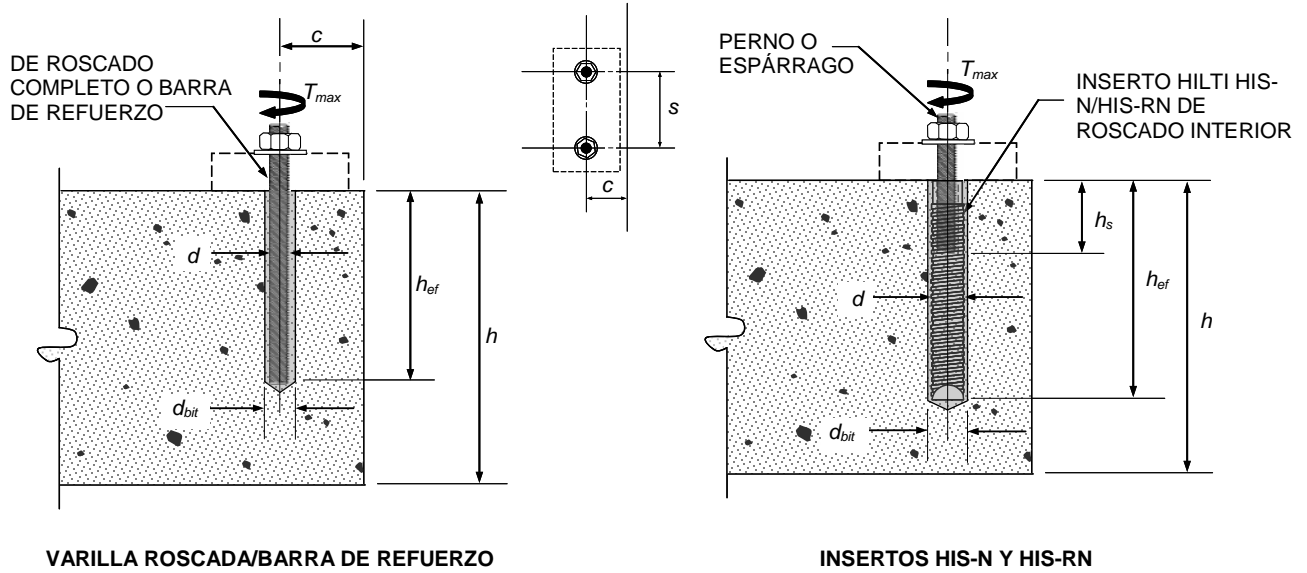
PARÁMETROS DE INSTALACIÓN PARA ANCLAJES ADHESIVOS POST-INSTALADOS
